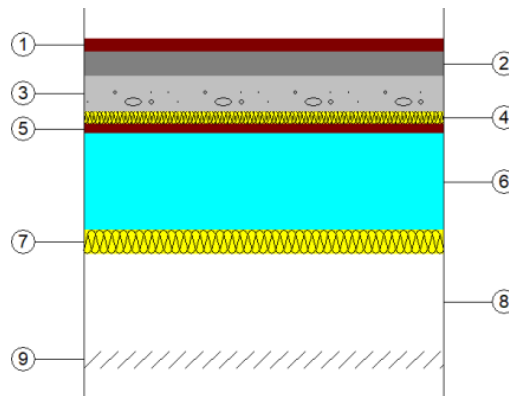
Detalle de forjado mixto madera-hormigón (Fuente: Tecnalia bloques en CAD y elaboración propia).
